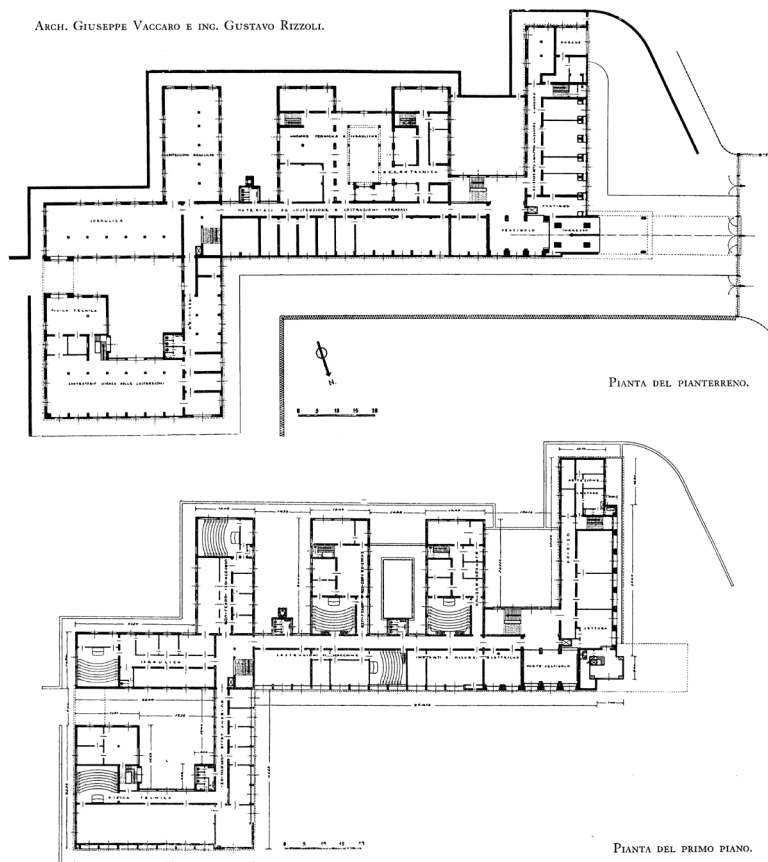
Pianta del piano terra e del piano primo (Vaccaro, 1936)
